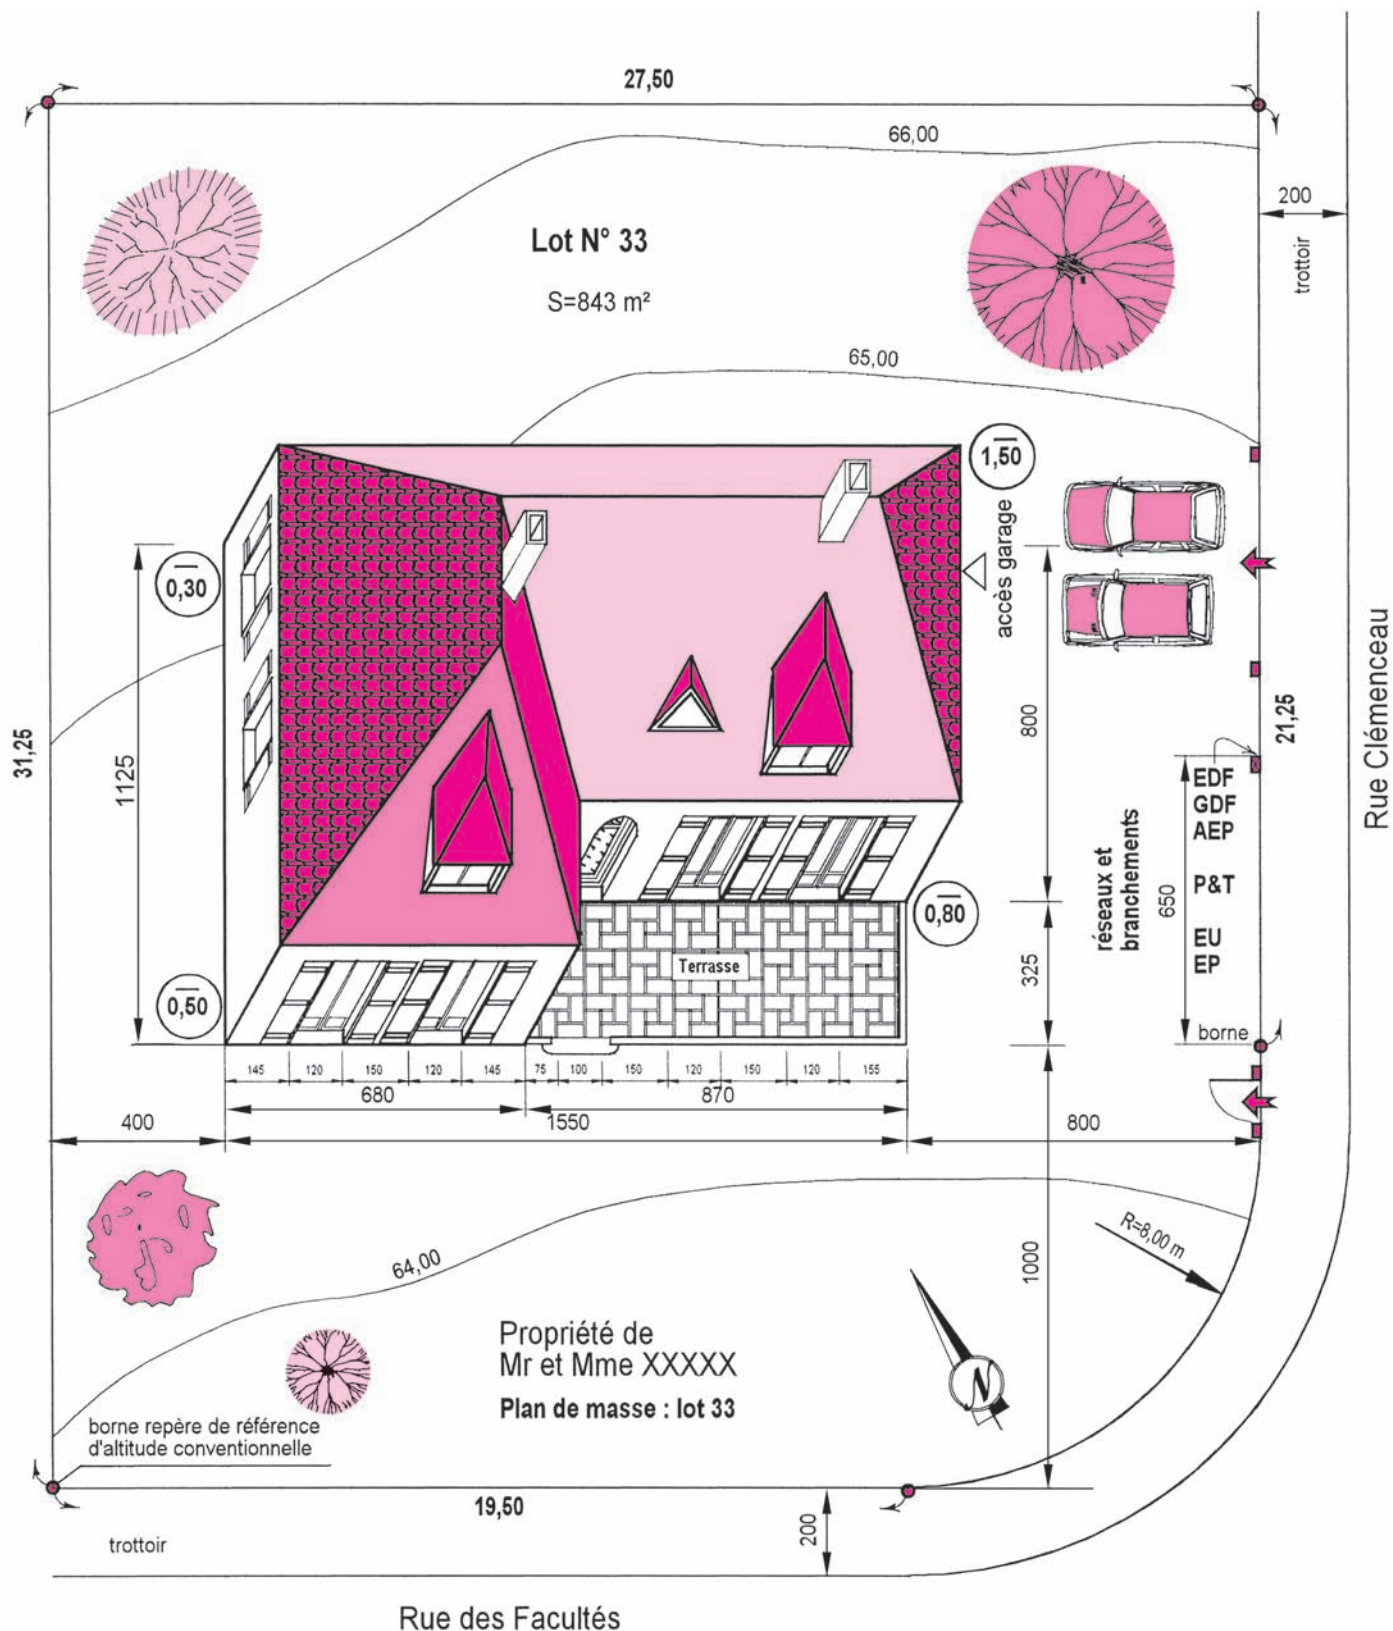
Plan de masse et position du coffret de branchement EDF
